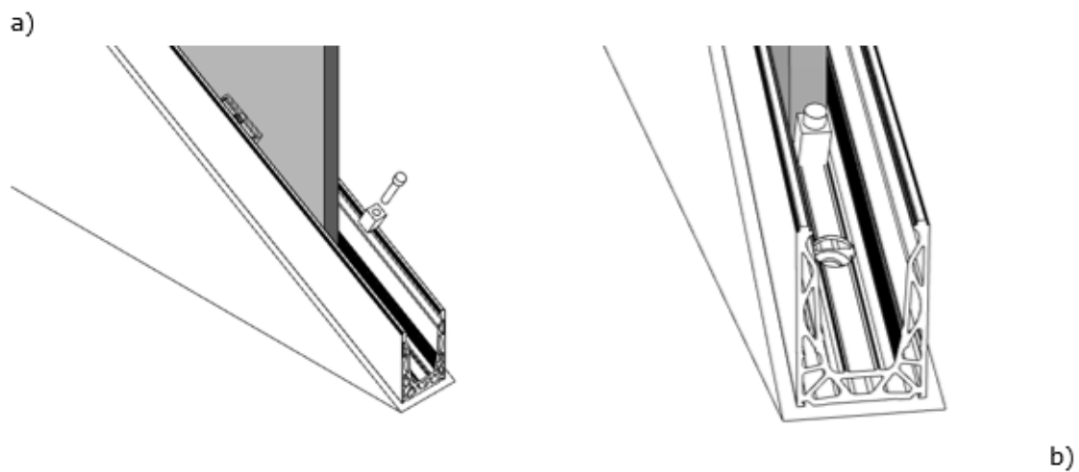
Installation d'une cale de maintien individuelle en partie basse du vitrage, pour pose en rampant
